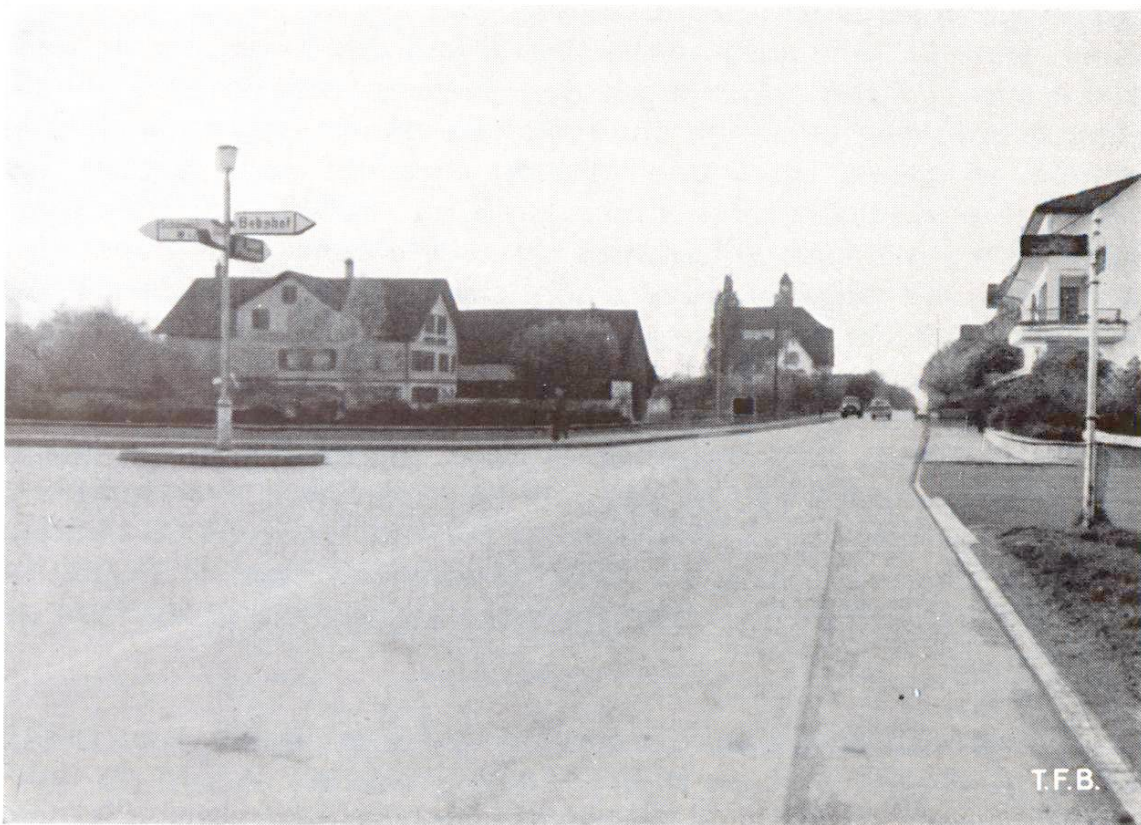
La place du village de Kradolf. Revêtement de la chaussée construit en 1932, îlot central et trottoirs en 1950 et 1952
